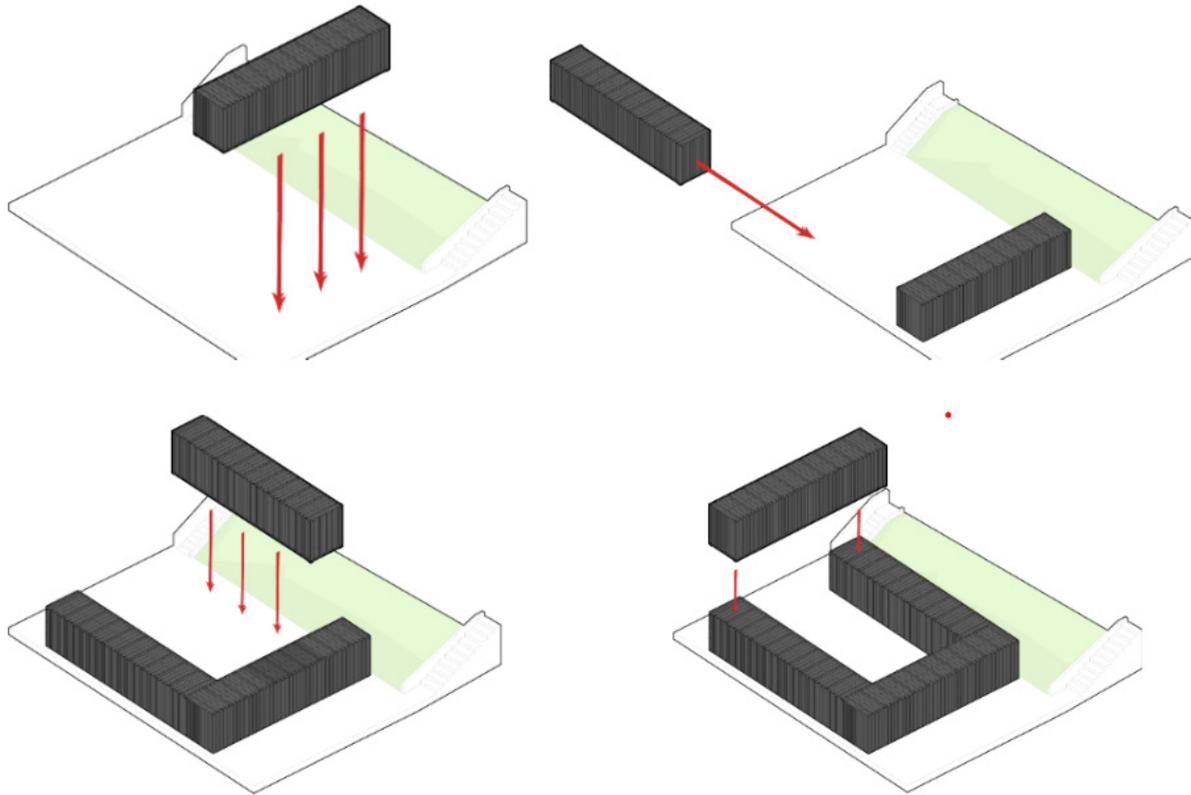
Modulación de conenedores para uso de Restaurante Container en Minas, Lagoa Santa - Brasil.
